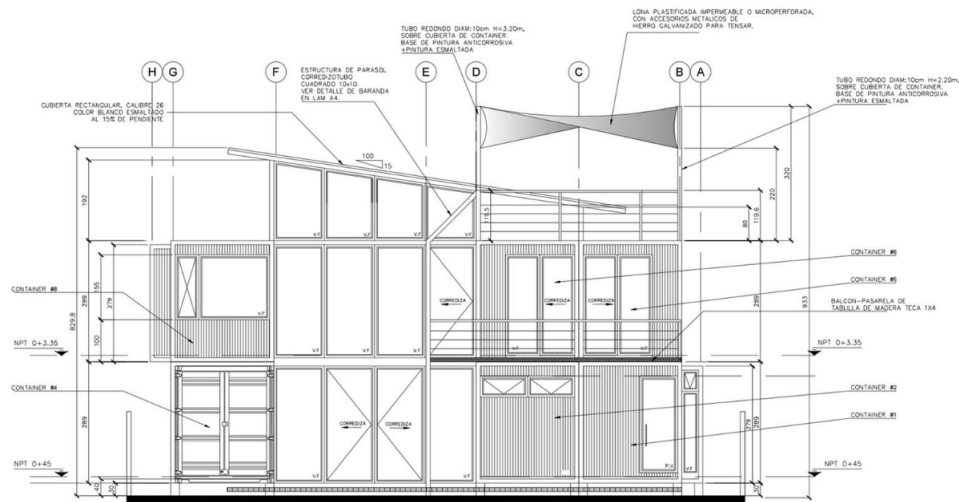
Ejemplo de planos de elevación sur. (Fuente: Planimetría(2018))
